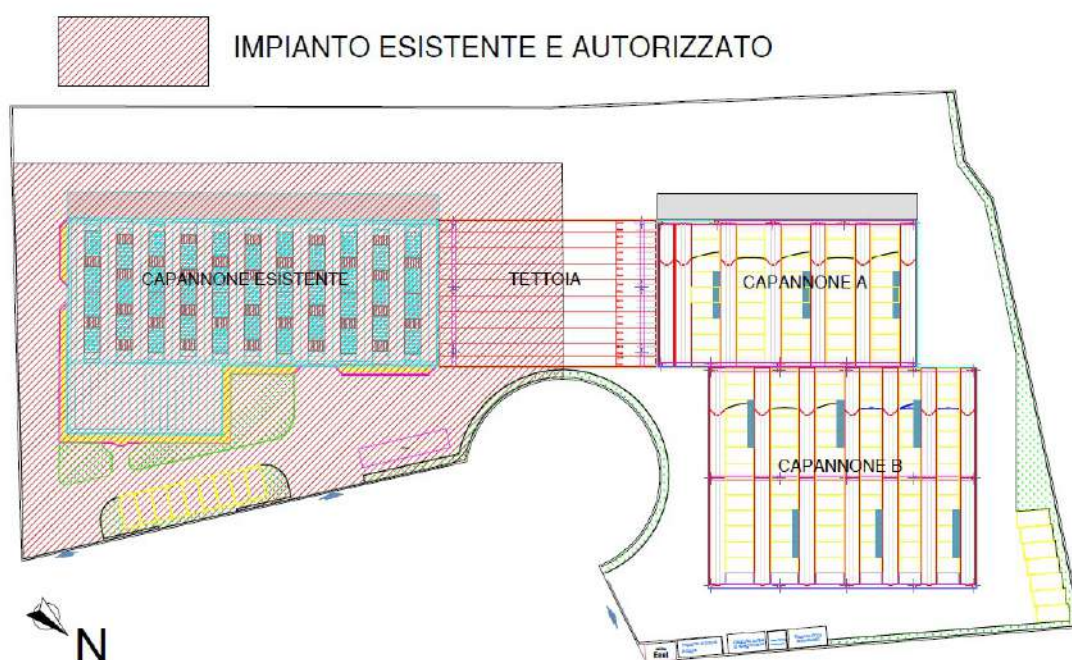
Planimetria Generale a seguito dell'ampliamento
